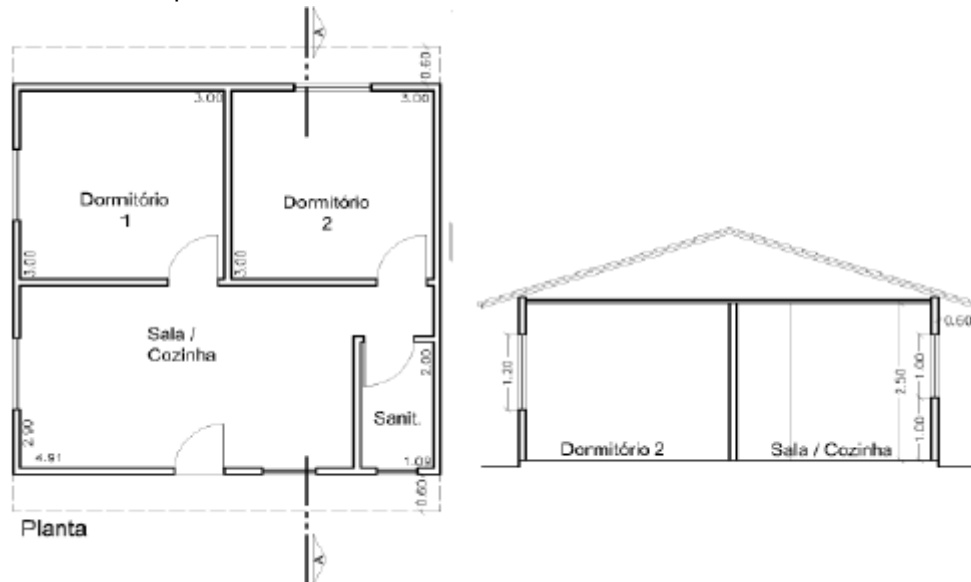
Projeto padrão (planta e corte) da edificação analisada com a tipologia 01, conforme Diretriz SINAT nº 001 – Revisão 03 – “Diretriz para Avaliação Técnica de Paredes Estruturais de Concreto Moldadas no Local (Concreto Leve ou Concreto Reforçado com Fibra de Vidro)” – Anexo A, *Procedimento para simulação computacional de taxa de condensação por ano.
